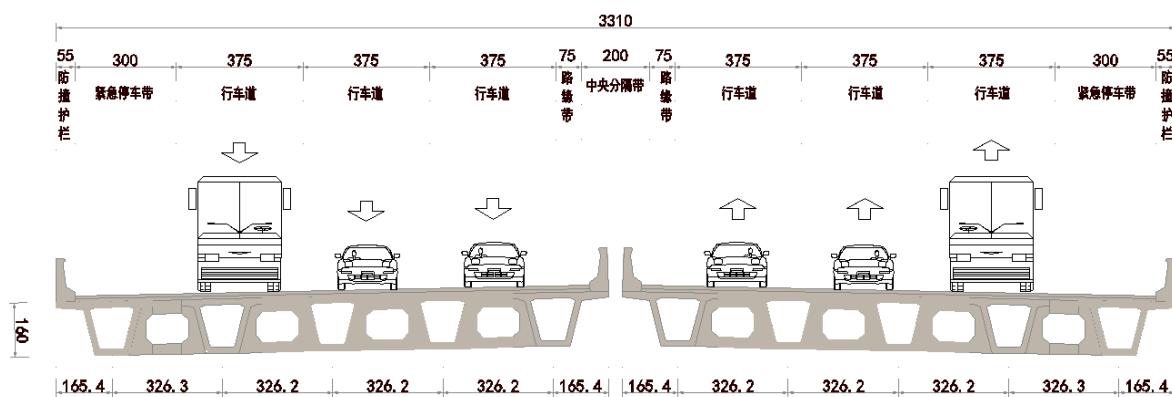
30m 主线桥预制小箱梁标准横断面布置示意图
